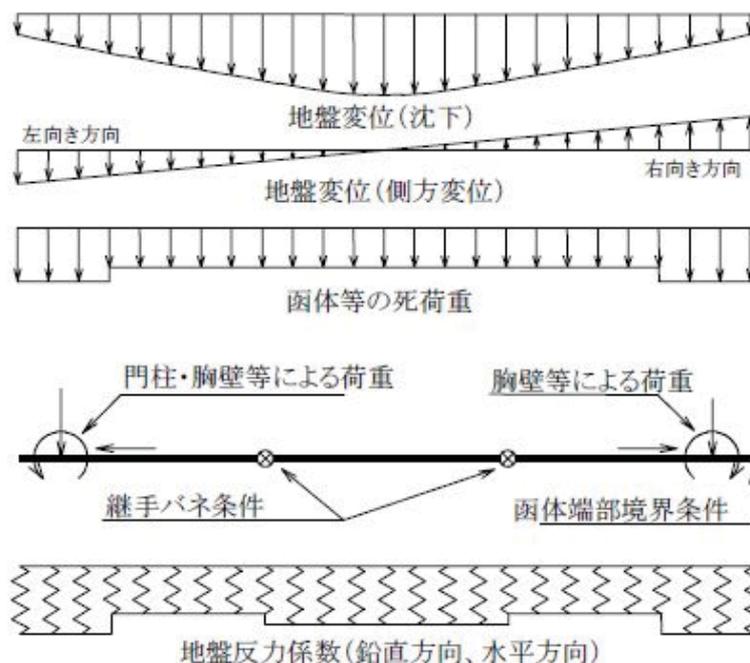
地盤変位の影響を考慮した弾性床土上の梁の設計モデル（柔構造樋門）
